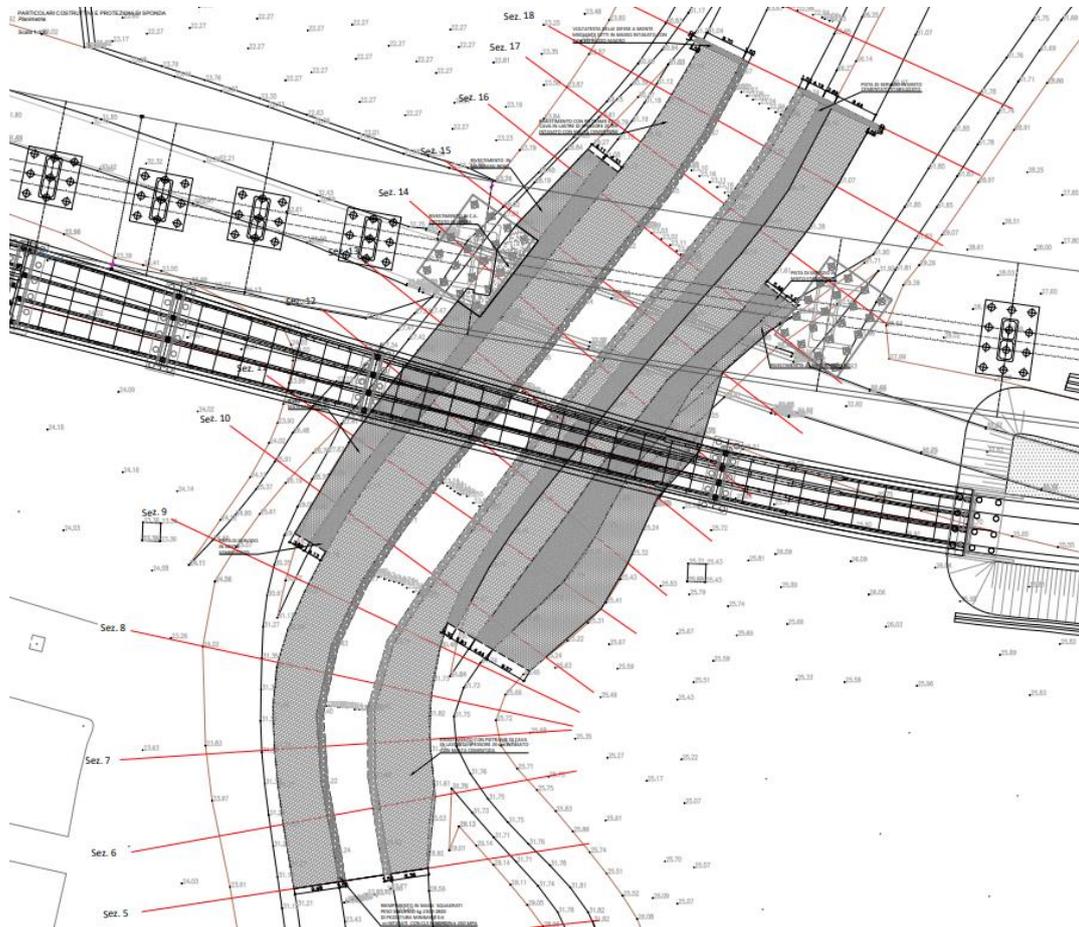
Planimetria rivestimenti di sponda post operam del PE.
